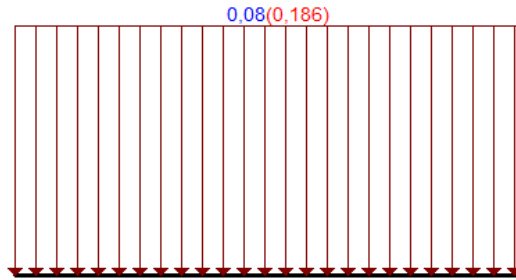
Схема прикладання снігового навантаження на покриття будівлі
